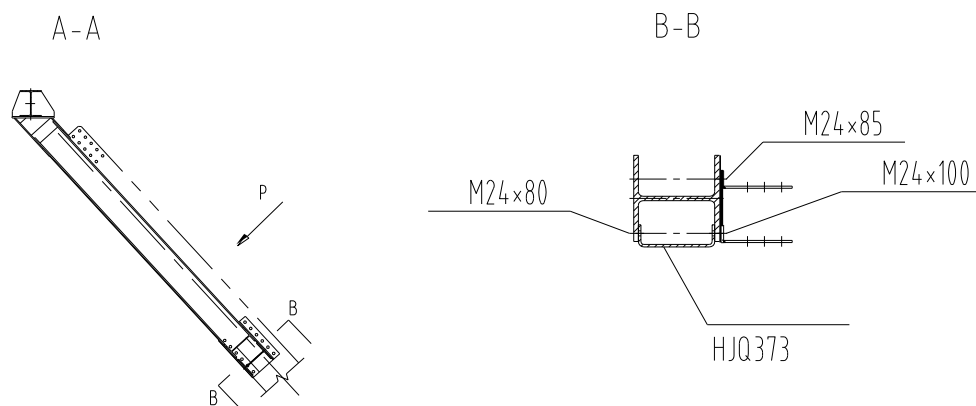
Detalle para la conexión de la entrada de 109.2m b
